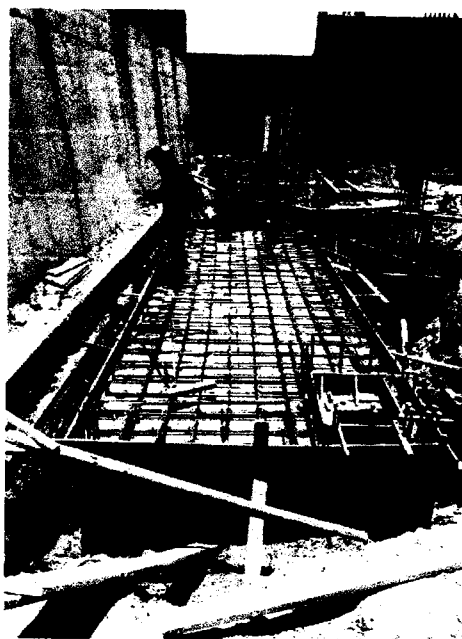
Se realizan los trabajos de habilitado de acero para losa superior. Tanque Séptico.
